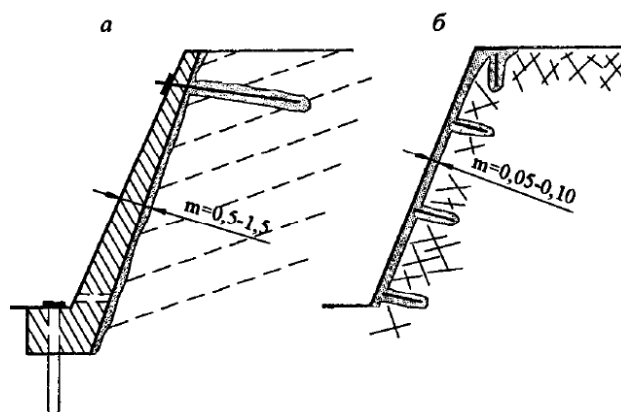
Схема железобетонной стенки: а – защитная на фундаменте; б – предохранительная
